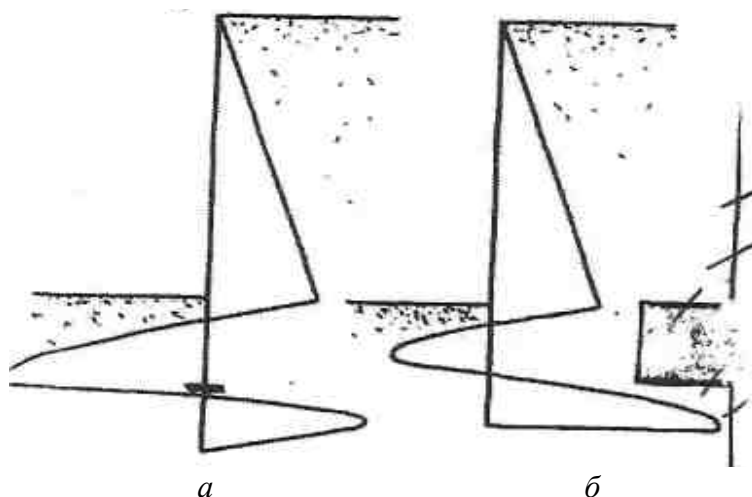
Схема давления грунта на незаанкеренную шпунтовую стенку: а – схема с заделкой в грунте; б – схема без заделки в грунте
